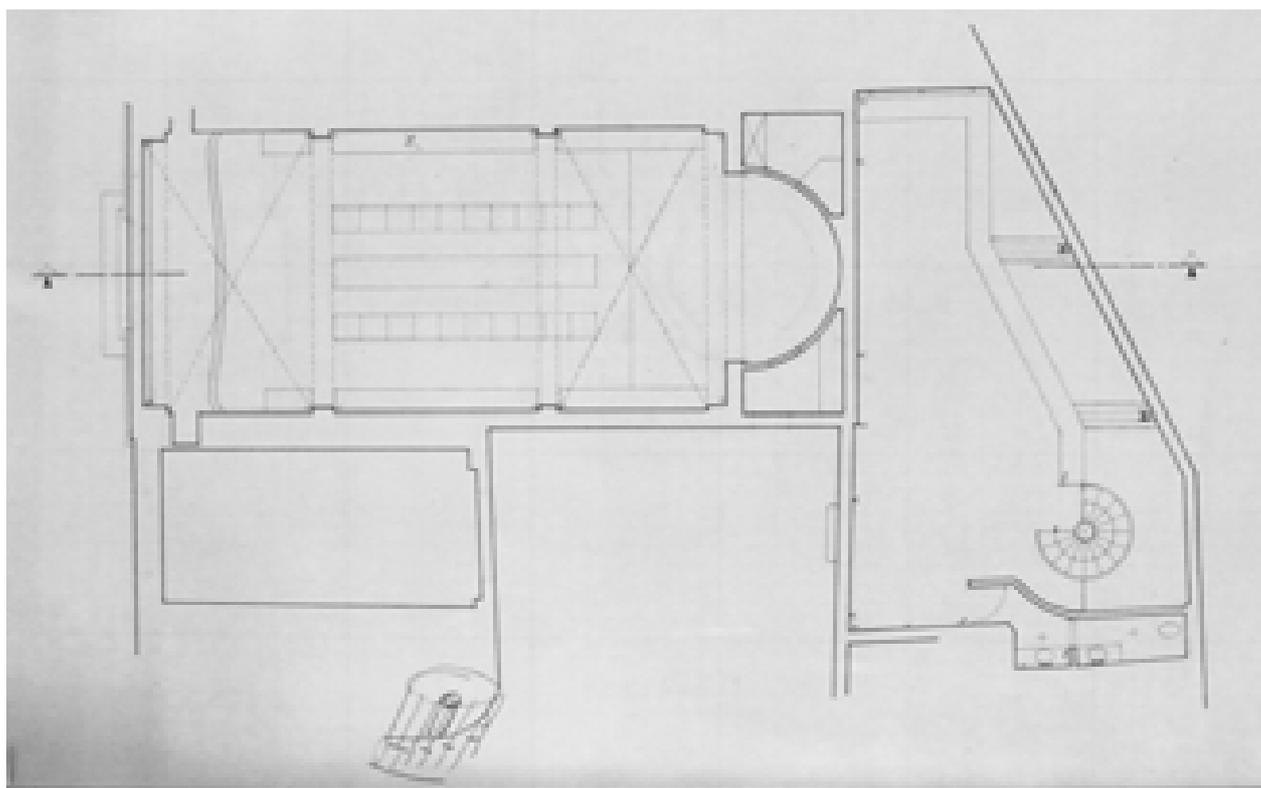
San Leonardo studio planimetria - s.d. (AABS-94.097)
